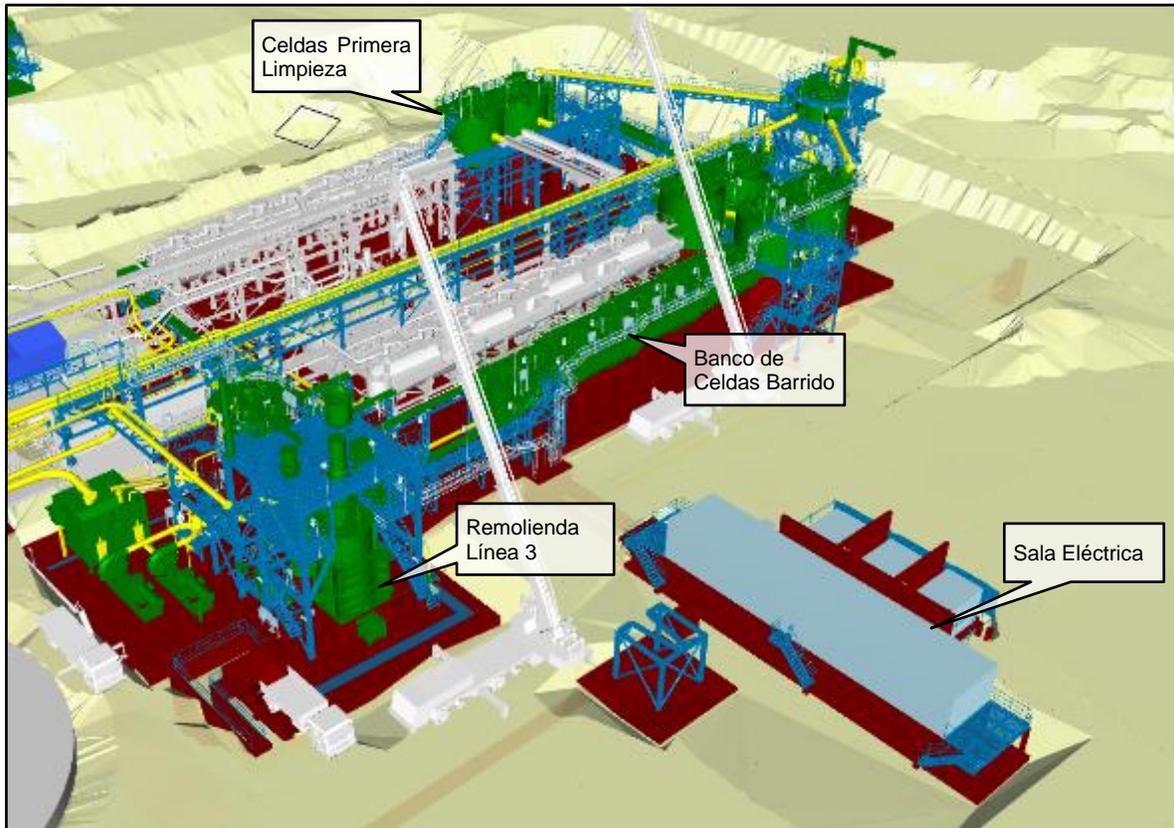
Modelo 3D Flotación 1ª Limpieza, Barrido y Remolienda – Área Flotación Colectiva
